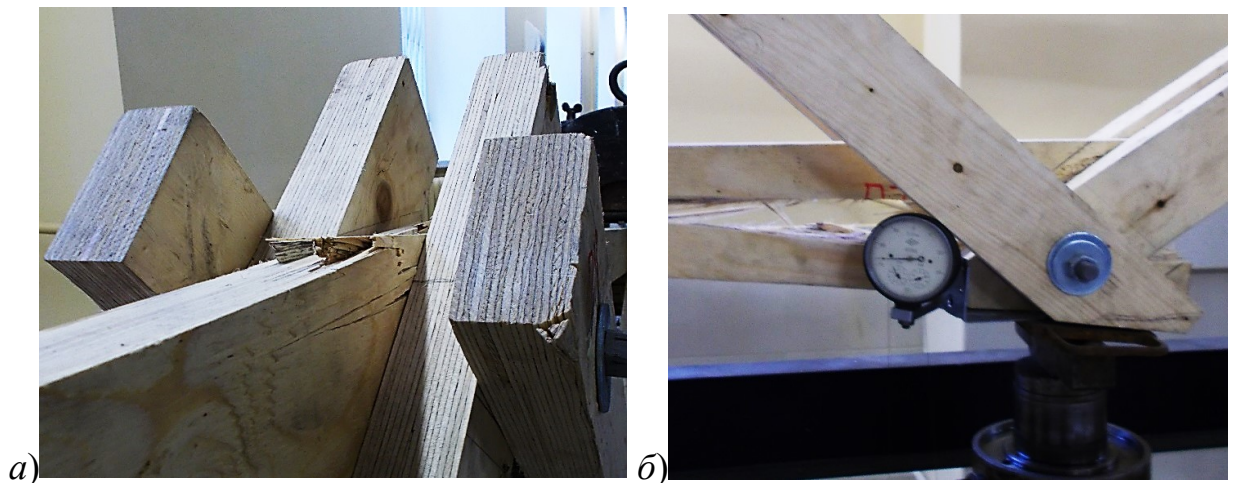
Узлы разрушенной конструкции фермы: *а)* нижний пояс (место установки П8) *б)* верхний пояс (место установки П7).
